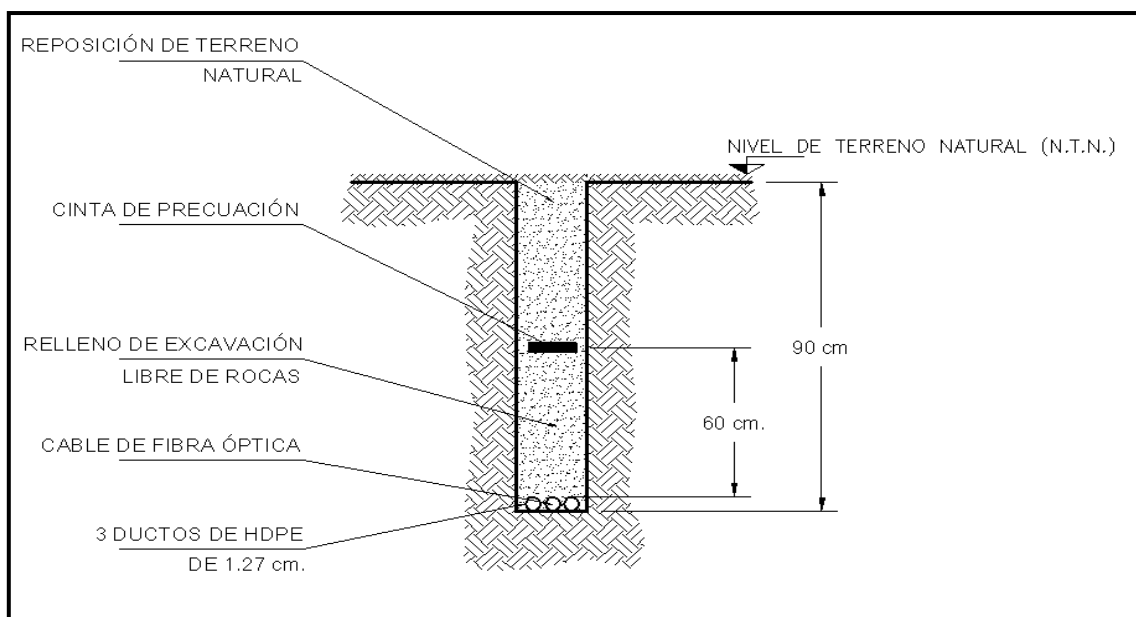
“CONSTRUCCIÓN DE ZANJA EN SUELOS TIPO B Y C”
